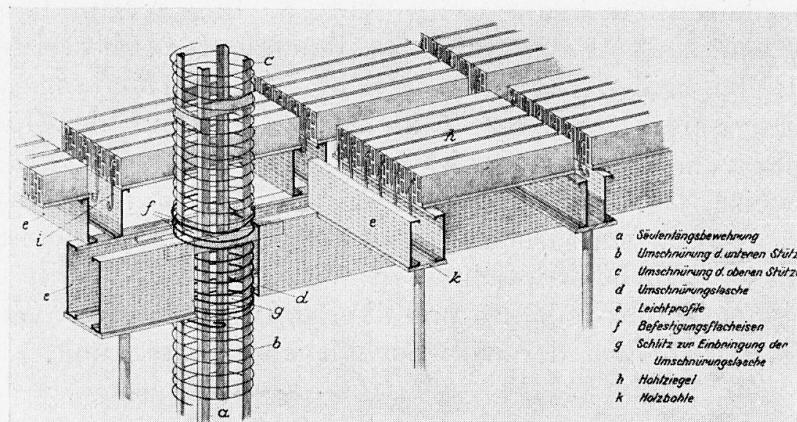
a Armature longitudinale du poteau = a Säulenlängsbewehrung = a Longitudinal reinforcement of pillar.
